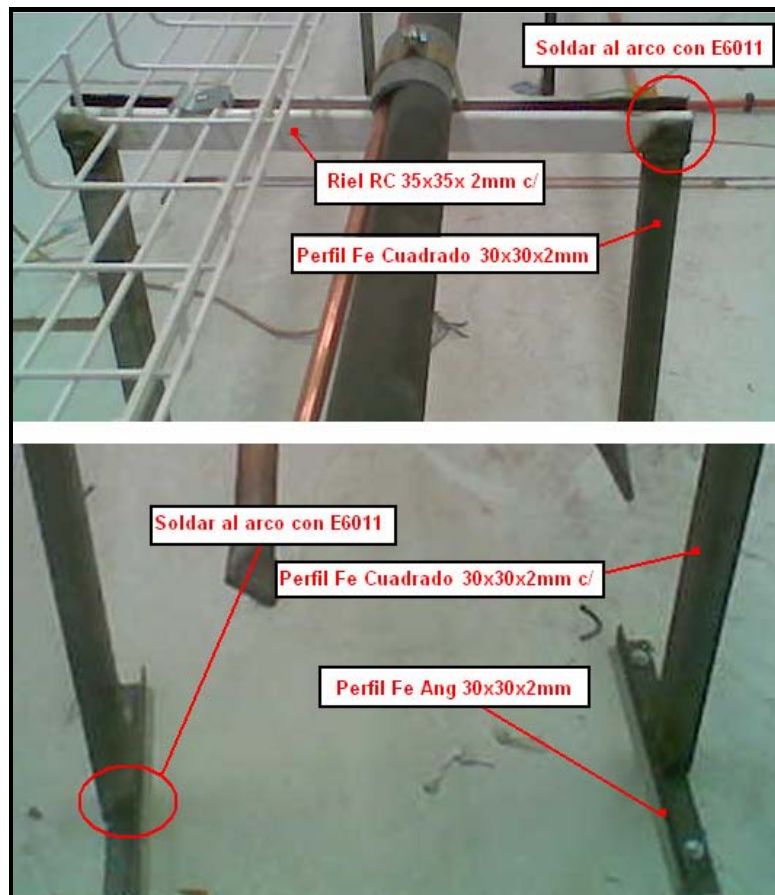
Unión de Soportación a través de soldadura.
